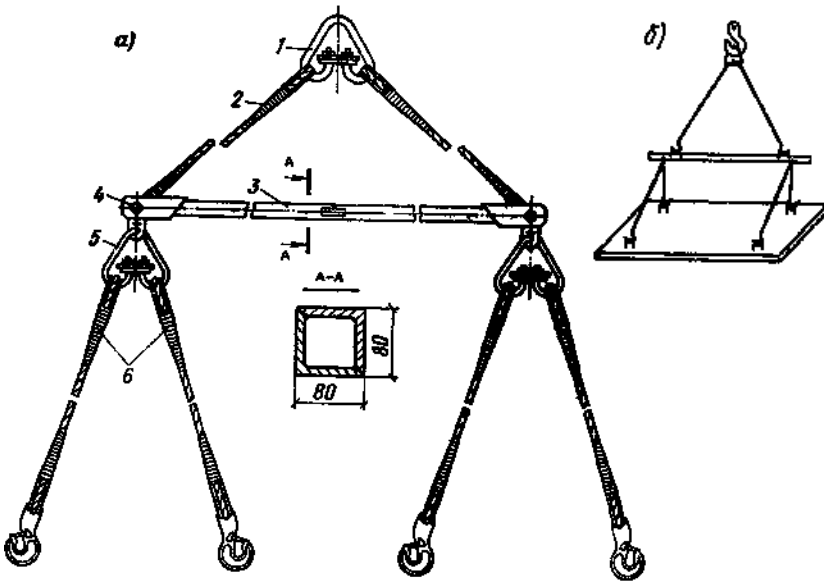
Траверса балкова із двохвітковими стропами: а - загальний вигляд; б - схема стропування; 1 і 5 - різні підвіски; 2 - канат-розтяжка; 3 - балка; 4 - замок кріплення; 6 - канатні стропи
